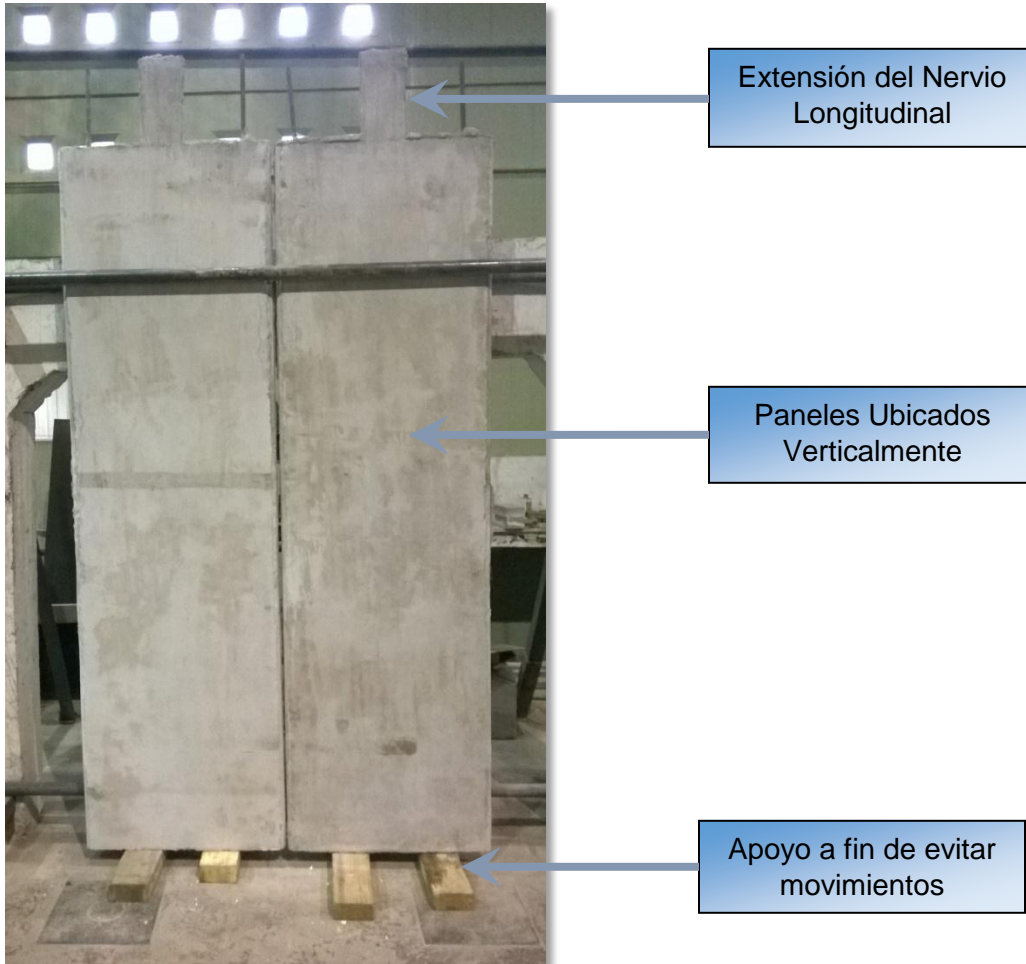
Detalle Armado de Paneles PL0765 en Dispositivo.
